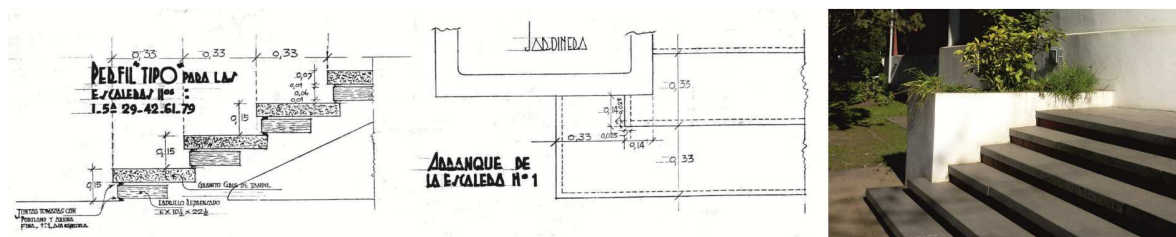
"Perfil tipo para las escaleras 1.5ª 29-42-61-79" y "Arranque de la escalera N°1", del plano "Cortes", 1937. Ministerio de Obras Públicas, en Archivo LEMIT y foto actual
